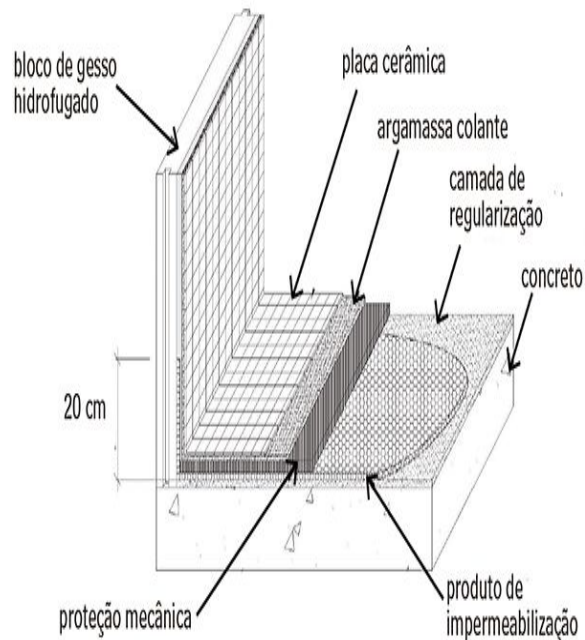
Detalhe executivo das áreas molhadas impermeabilizadas
